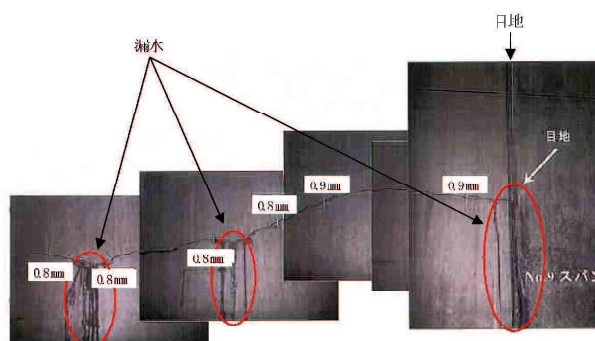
Cトンネルにおけるひび割れ発生状況 (SLよりやや上方)⁷⁾
